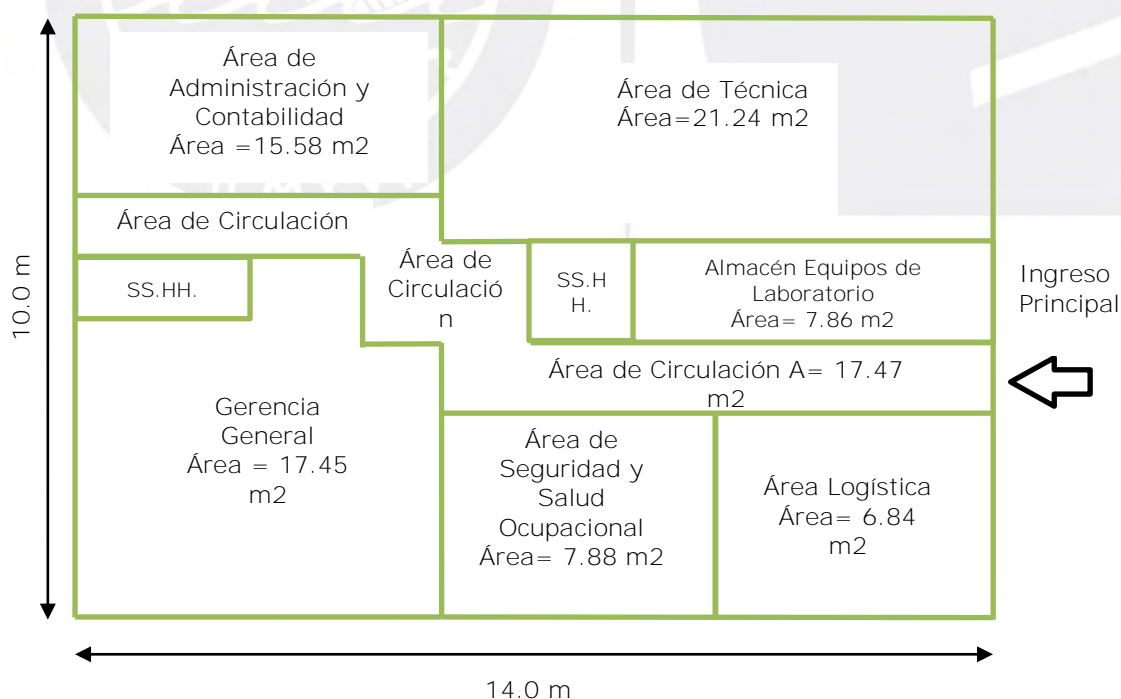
Dimensionamiento de planta actual de la sede central de la empresa ICYA
